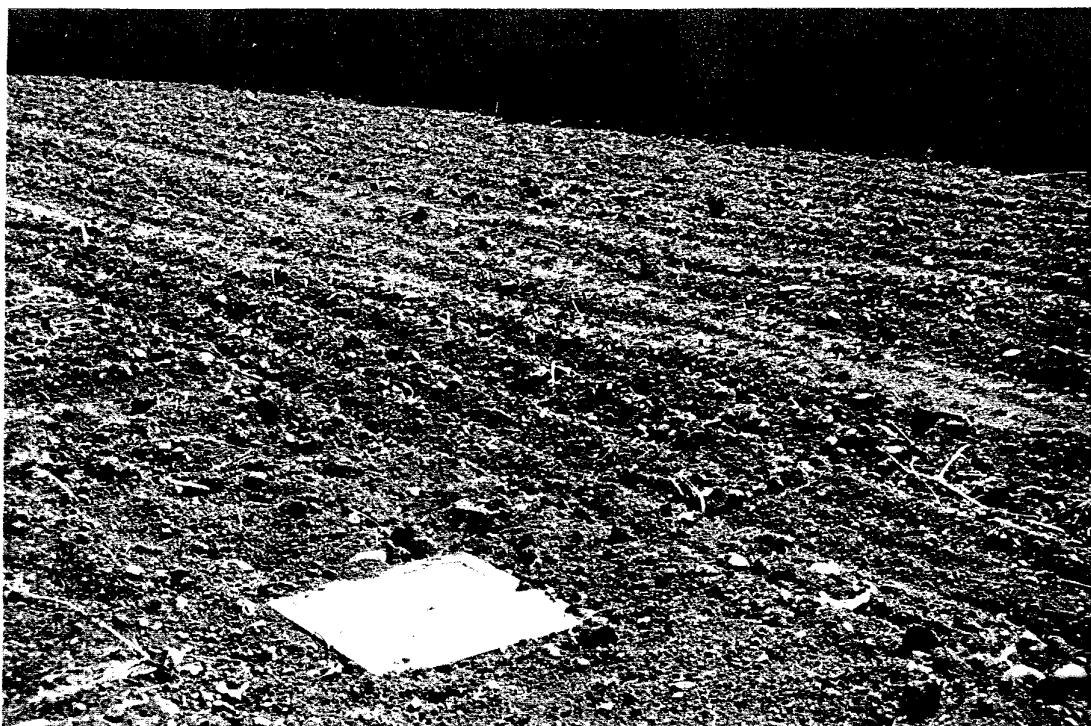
Stesura finale del terreno di copertura vegetale con vista del pozzetto di ispezione ovest
